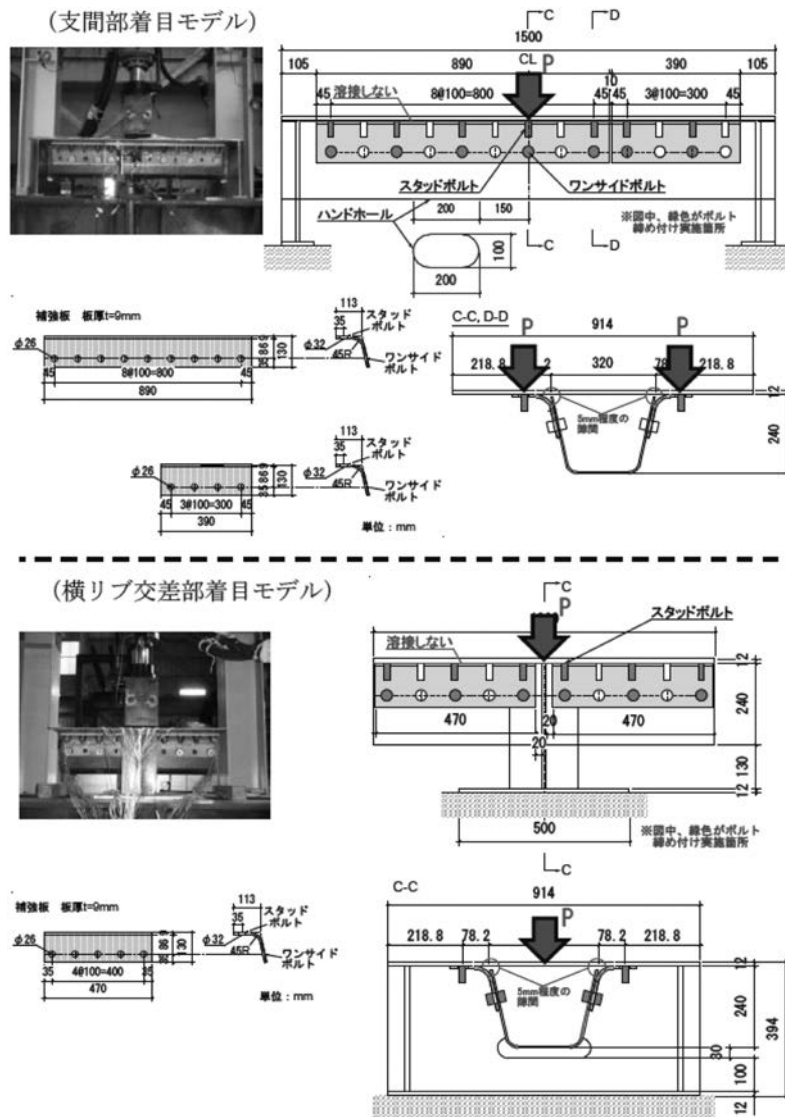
小型鋼床版試験体の形状および寸法 (単位: mm)
